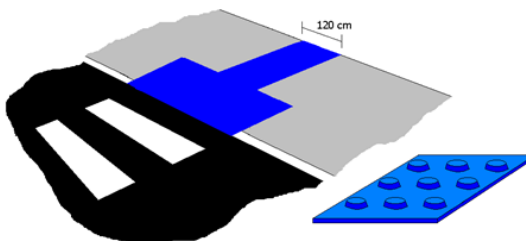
Pavimento tátil de alerta na faixa de aproximação e de presença
